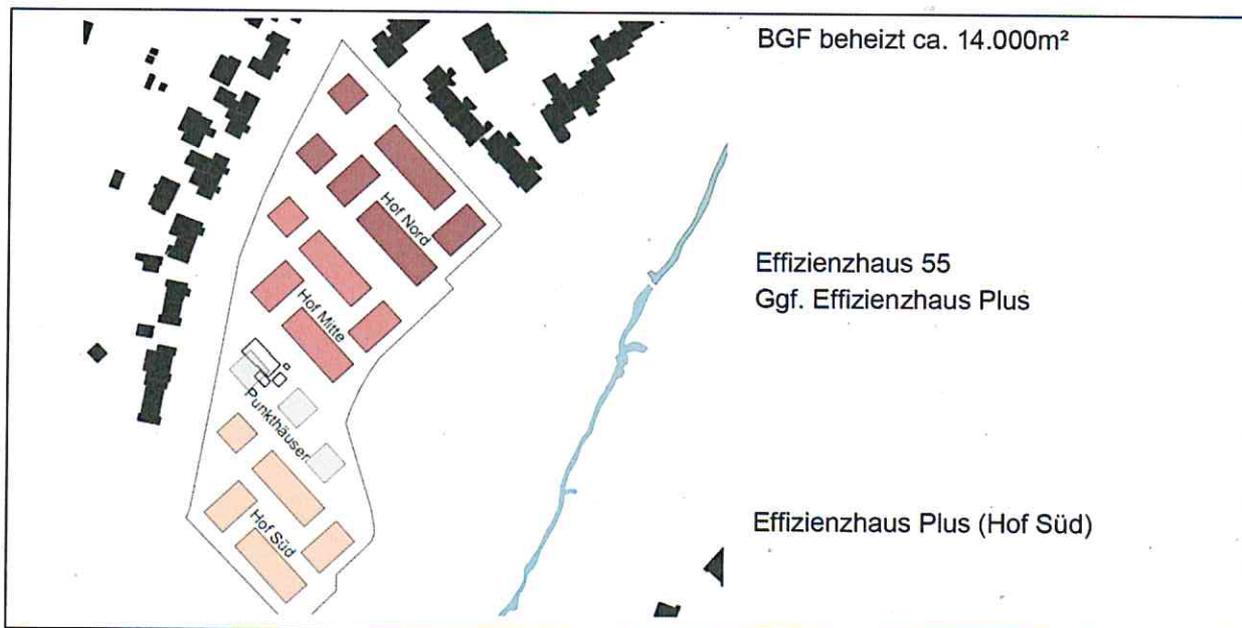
Lageplan Baugebiet Buckhörner Moor Norderstedt (Quelle: pbp Architekten)
